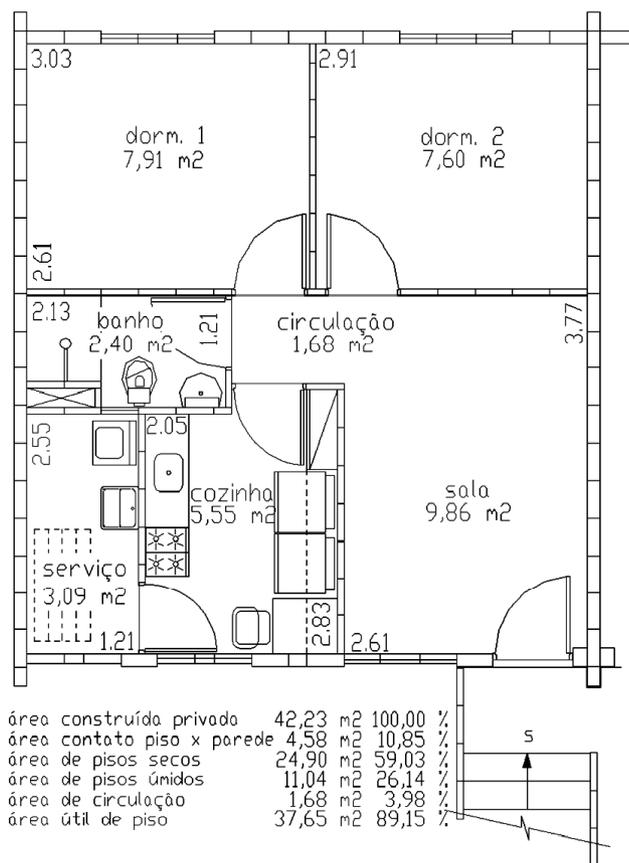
Planta 6 – Projeto original com alterações no setor hidráulico, sem alterações na área construída
